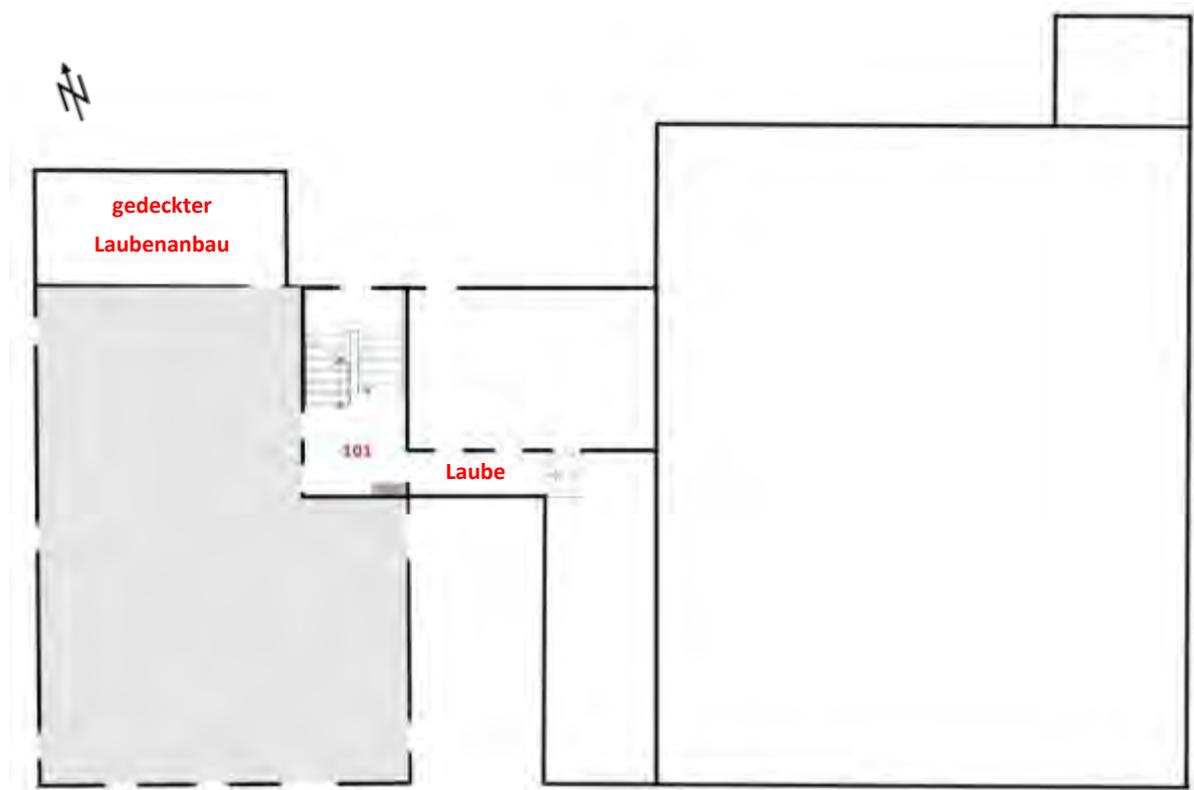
Schematischer Grundriss 1. Obergeschoss. Bearbeitung IBID.
